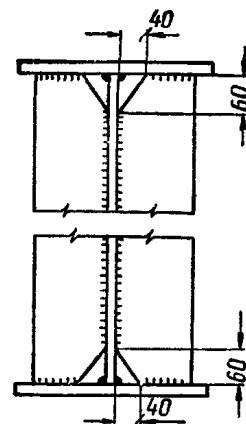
Схема примыкания ребер жесткости к поясам сварных балок
